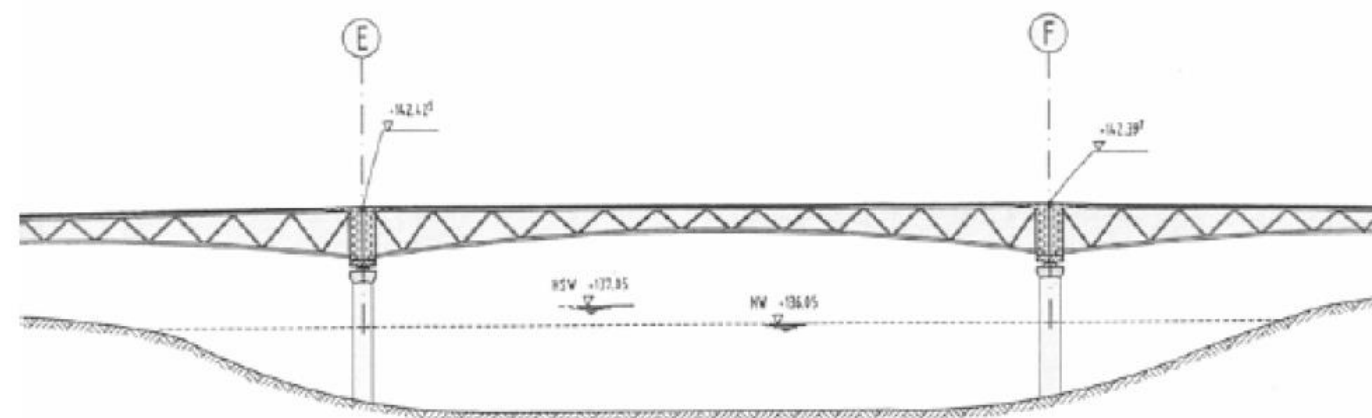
Alzado longitudinal de la pasarela sobre el río Fulda [Fehling 2009]
